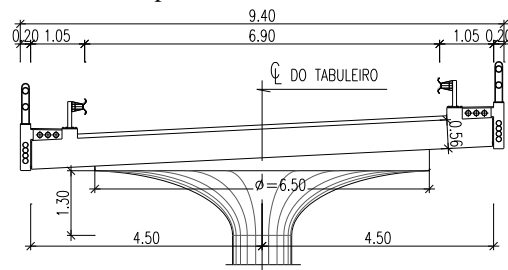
Secção transversal Ramos - 1 faixa de circulação.
